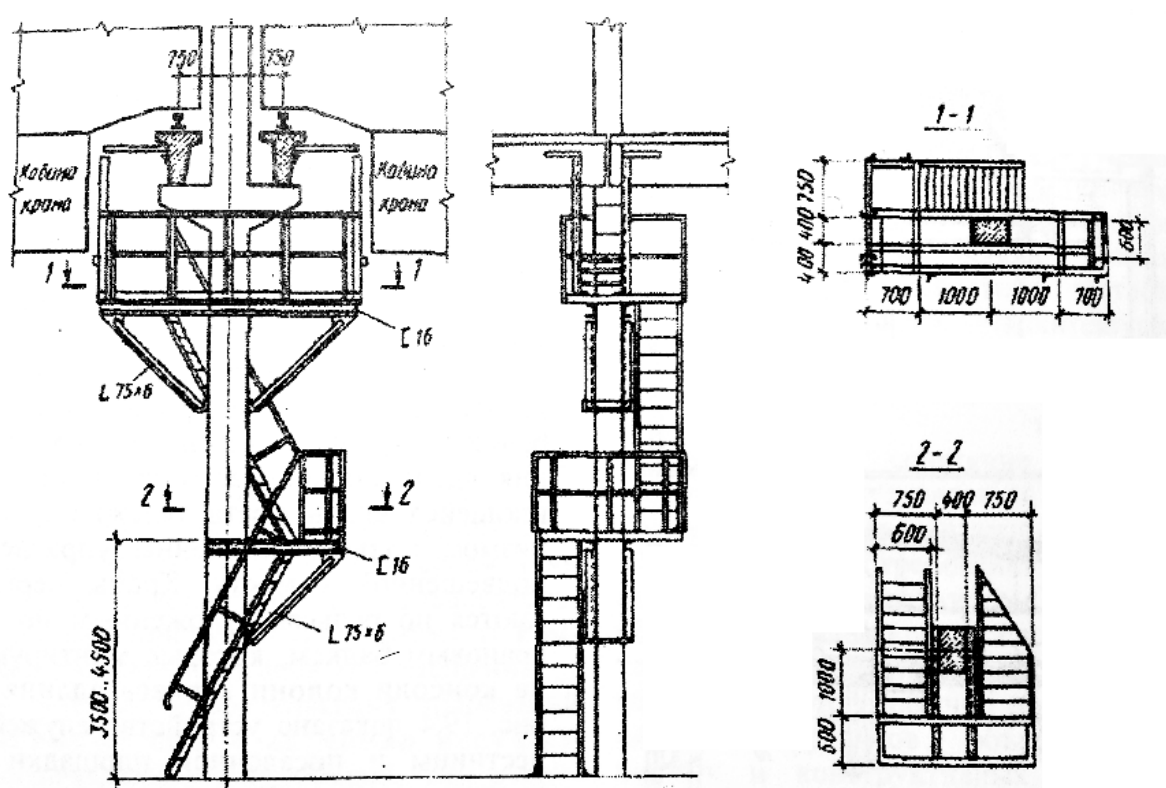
Устройство служебной лестницы и посадочной площадки для мостового крана у внутренней колонны цеха
